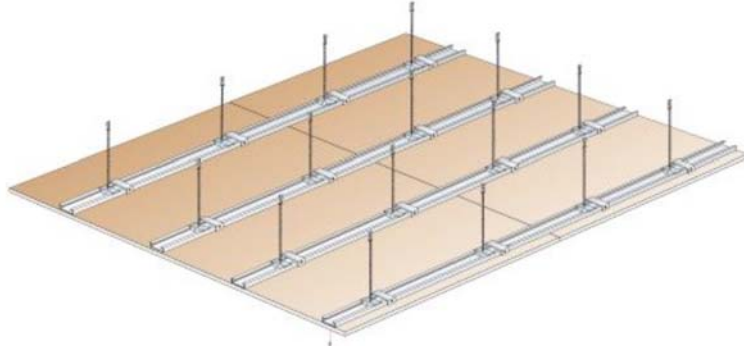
Plafond MASTERIMPACT RH sur fourrures S47
